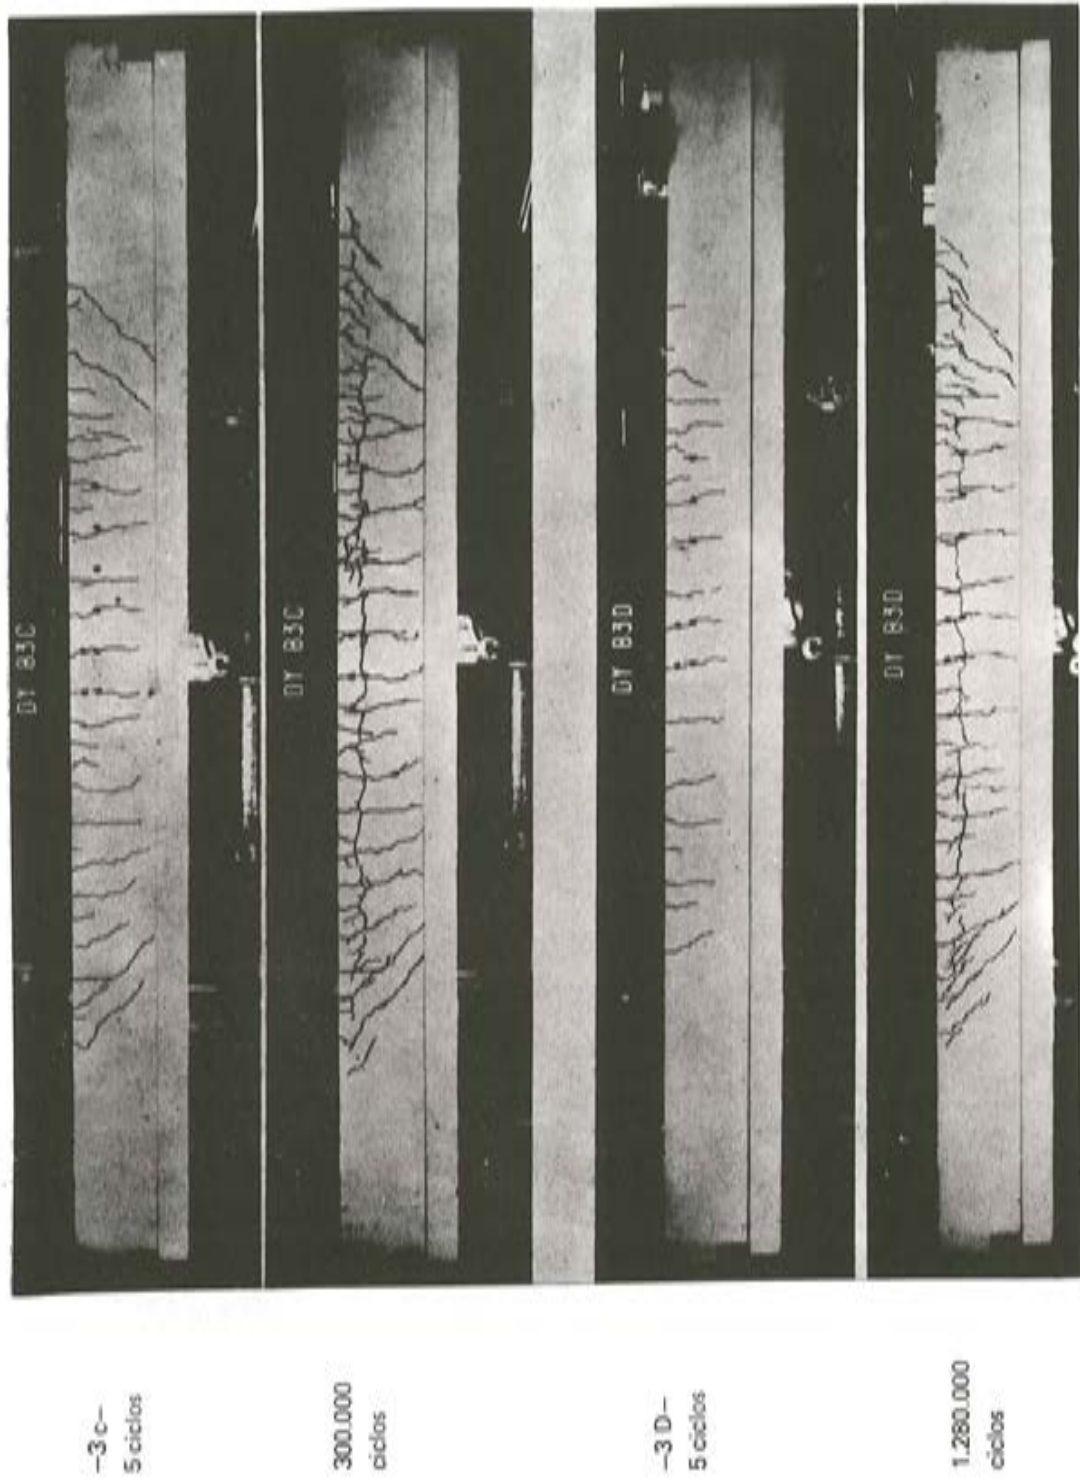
Fisuración de las viguetas durante los ensayos.
